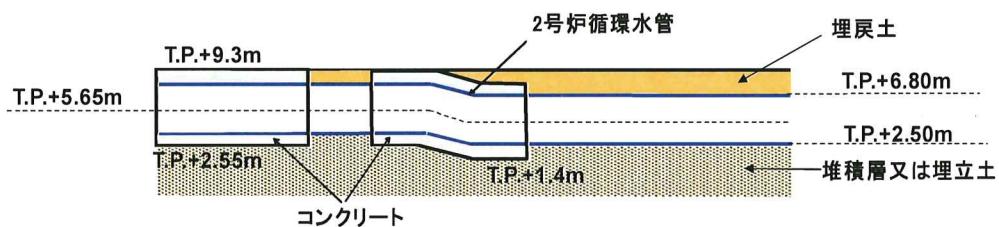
1, 2号炉循環水管埋設部⑥断面図
